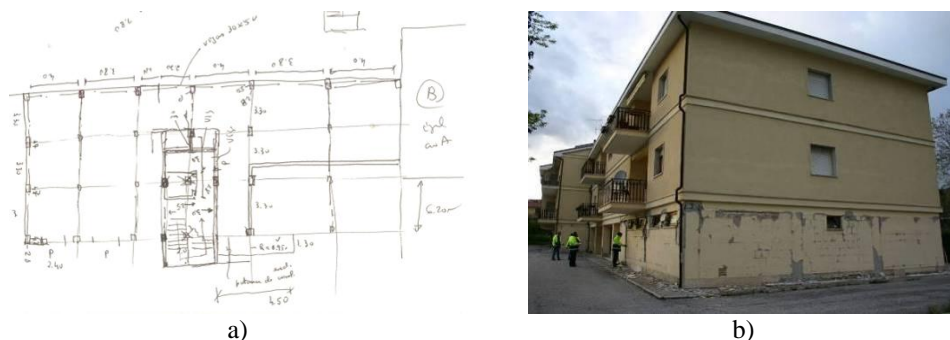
a) Esquema estrutural (planta do R/C) b) vista geral do edifício
